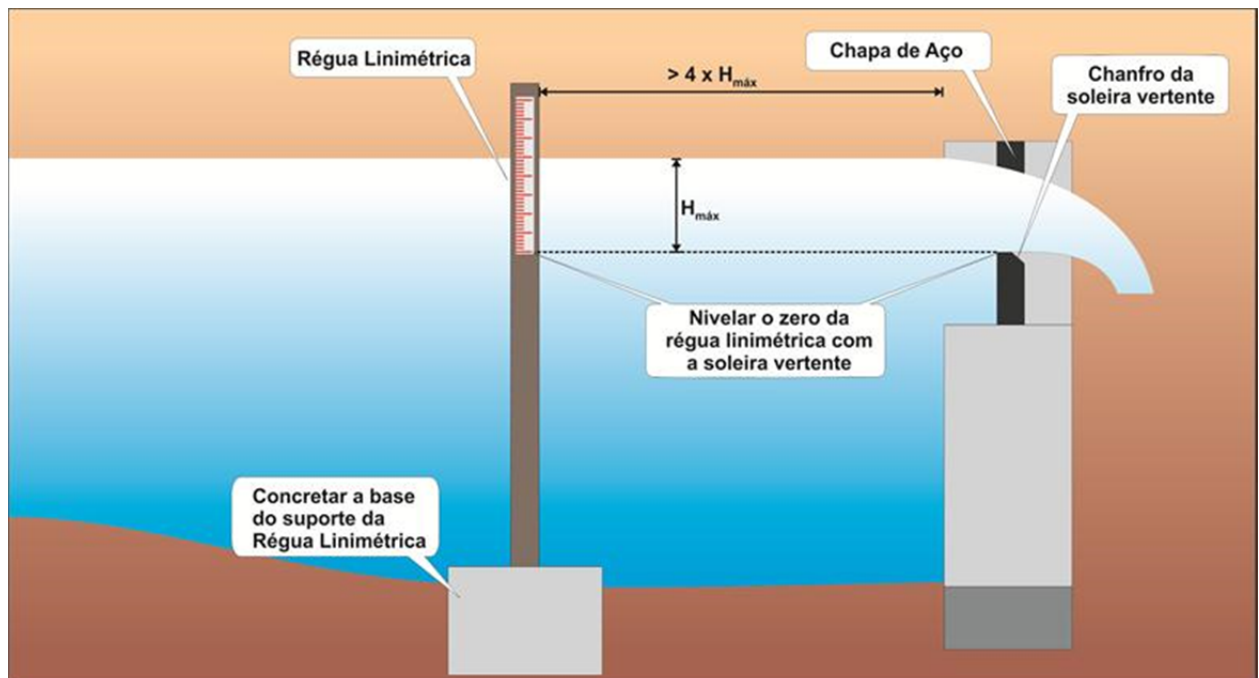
Desenho esquemático do vertedouro trapezoidal trapezoidal (Cipolletti)– Seção Transversal.
